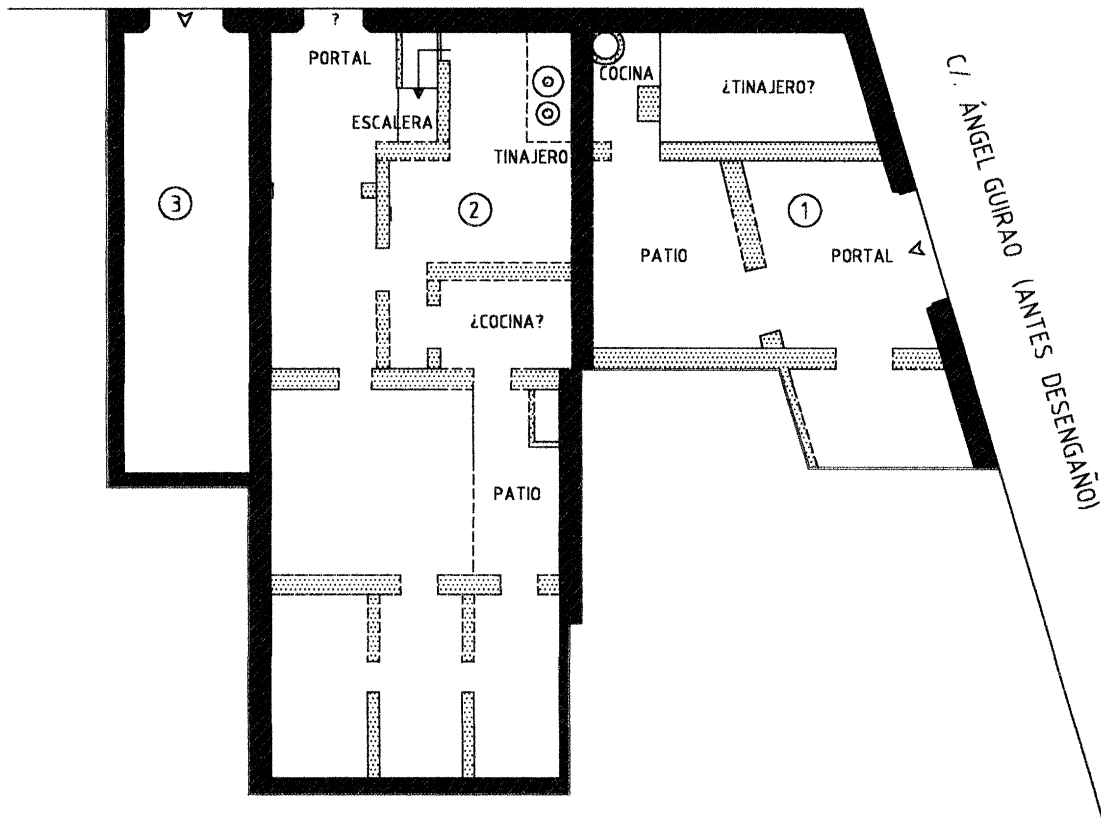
Planta de las viviendas (siglos XVIII-XIX).
